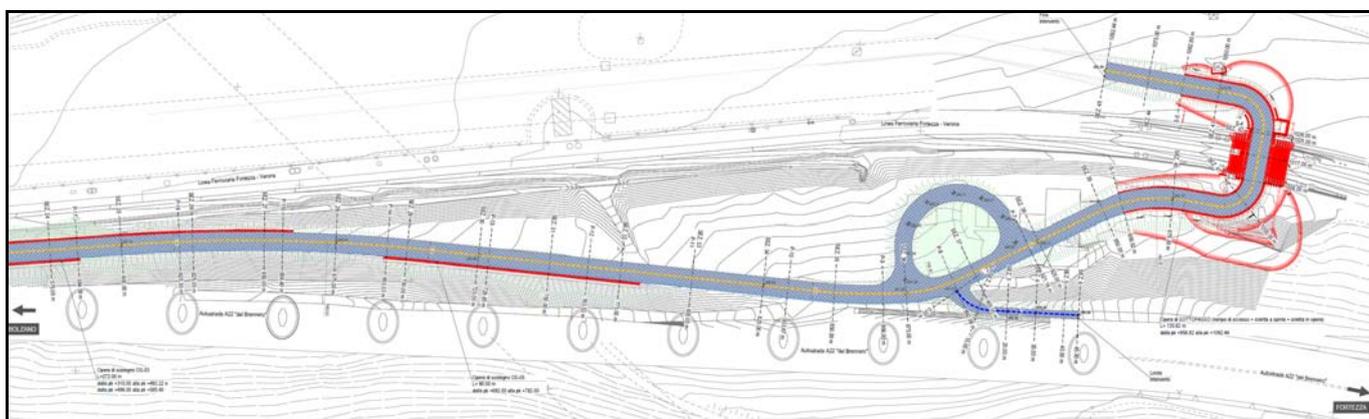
Planimetria di progetto (tra le progressive 0+575.00 m e 1+92.44 m)
